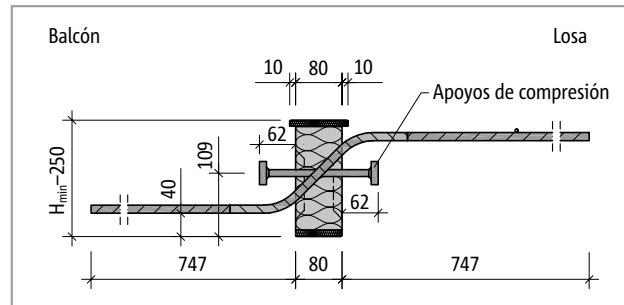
Schöck Isokorb® T tipo Q-P-V8 hasta Q-P-V9: Sección del producto
